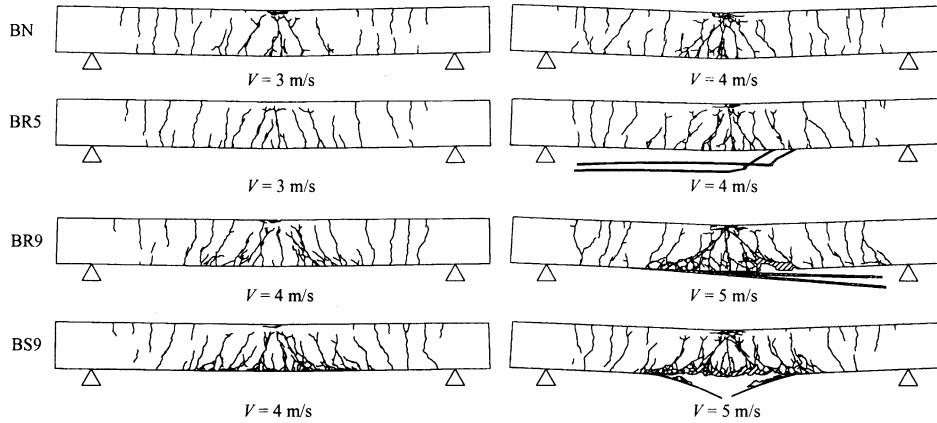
RC 梁のひび割れ性状(単一衝撃载荷)
